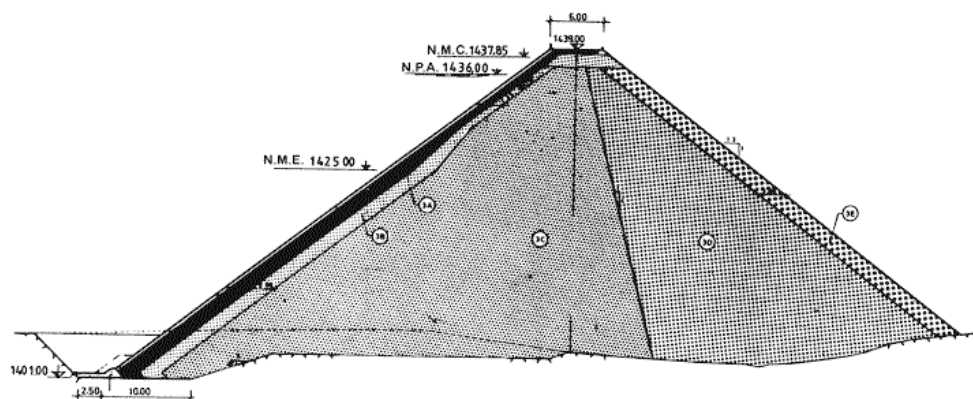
Barragem do Lagoacho. Perfil transversal da barragem de enrocamento compactado com cortina de betão a montante.
